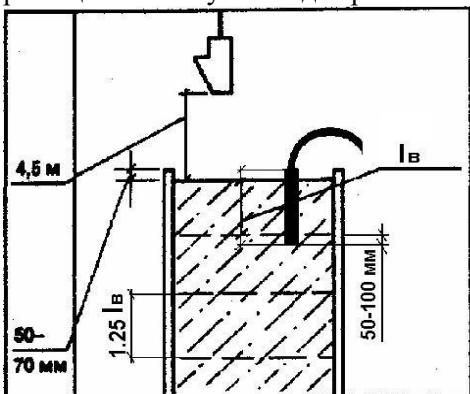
Допуски при бетонуванні фундаментів
